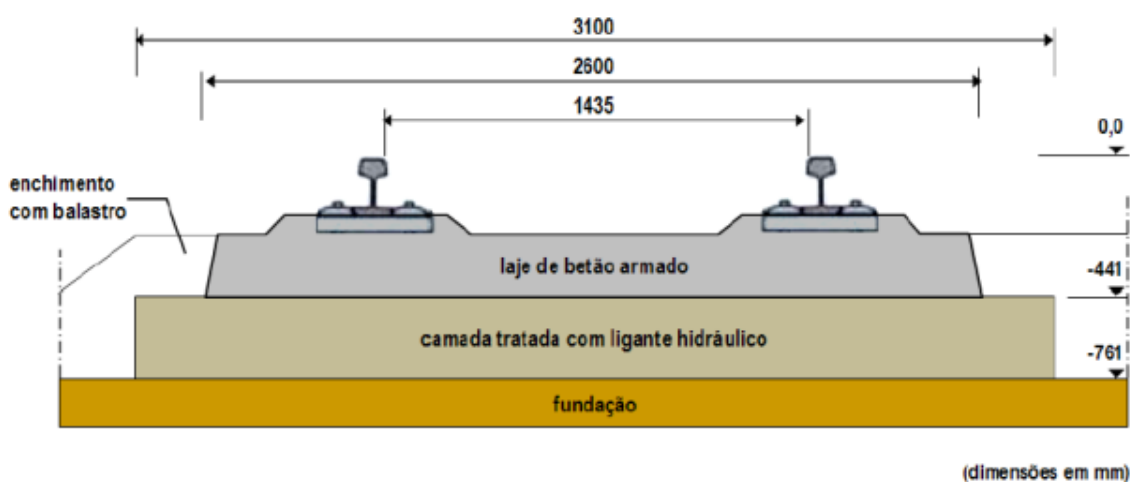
Perfil transversal esquemático da solução BTE (Paixão & Fortunato, 2009)
